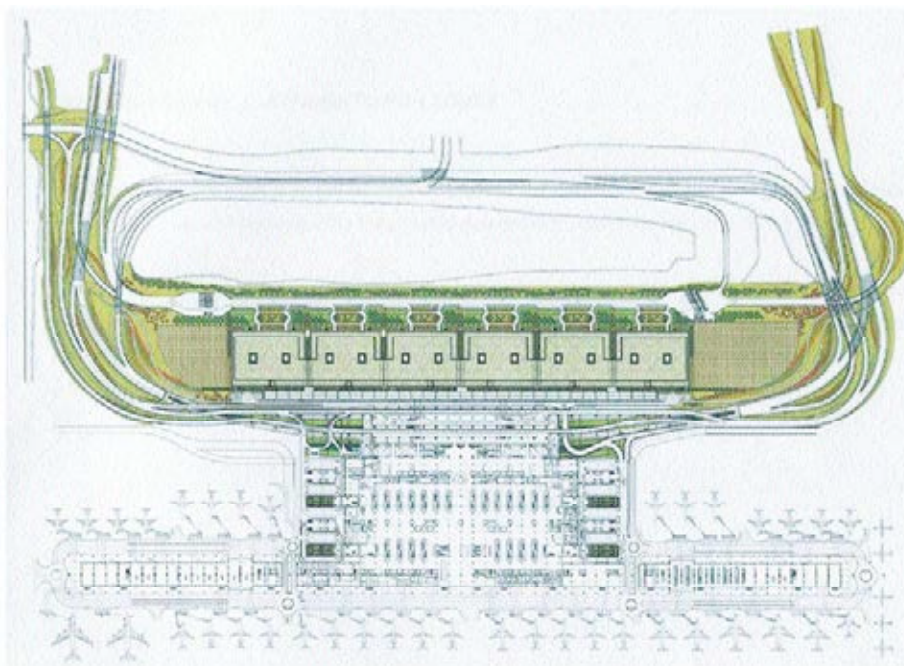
Planta general de viales de accesos y estructuras proyectadas.
